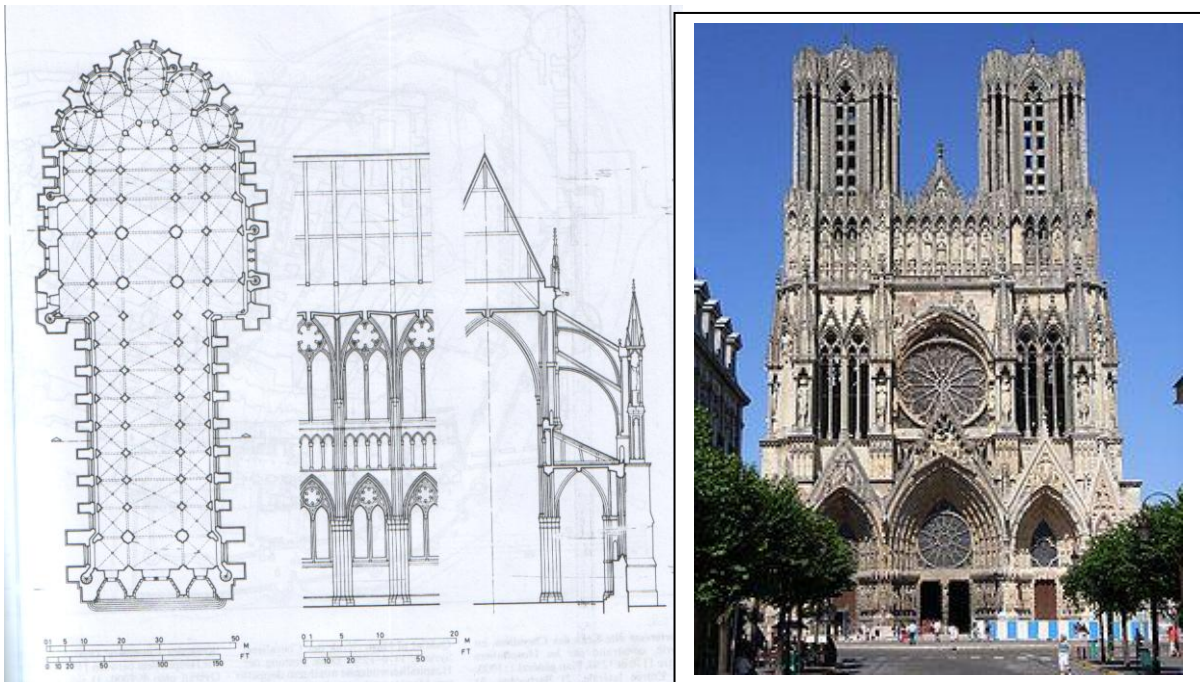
La cathédrale Notre Dame de Reims : plan, coupe et élévation Source (Stierlin, 1977, p169)
